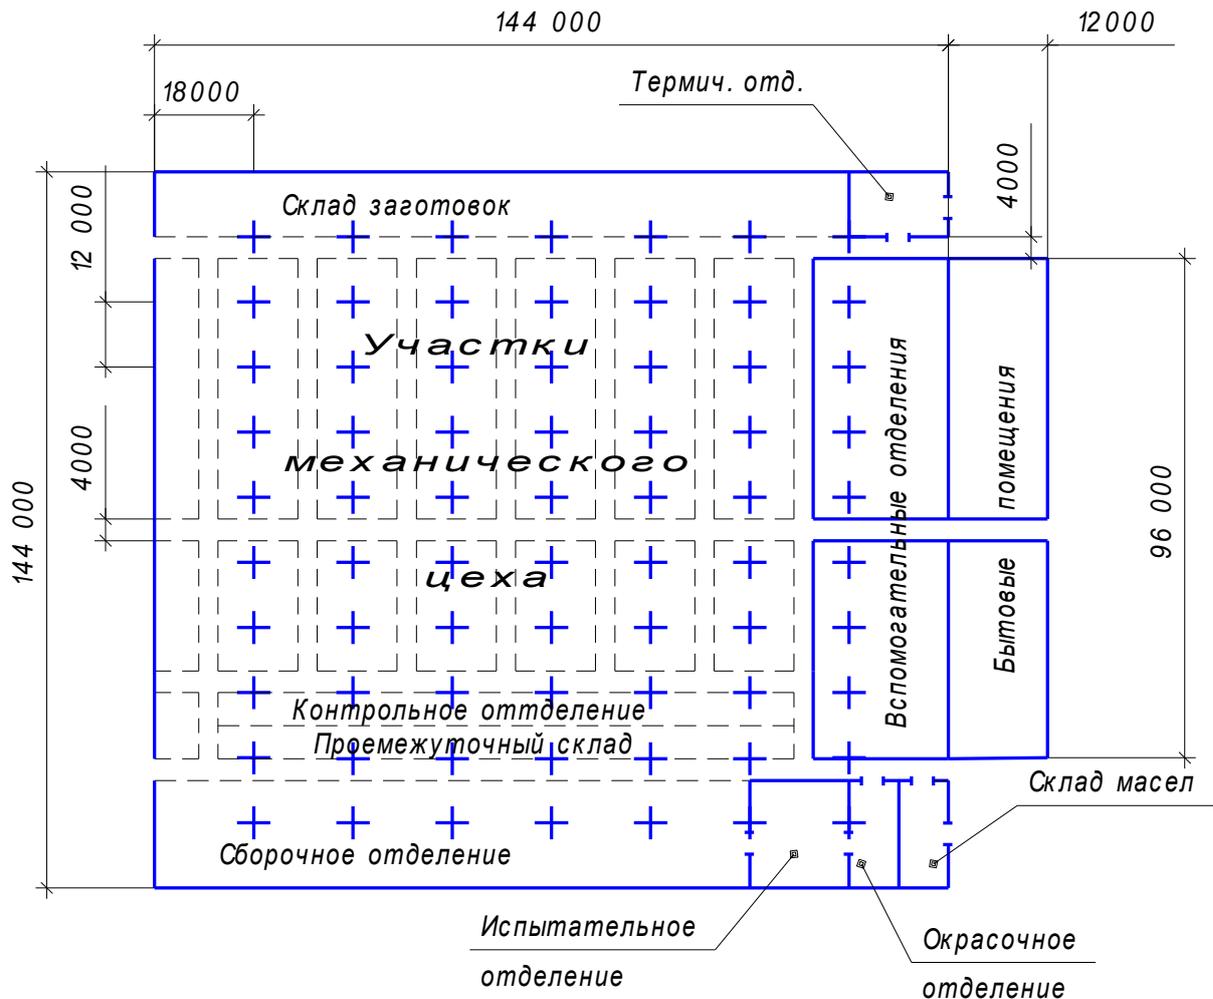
Пример компоновки корпуса механосборочного цеха
